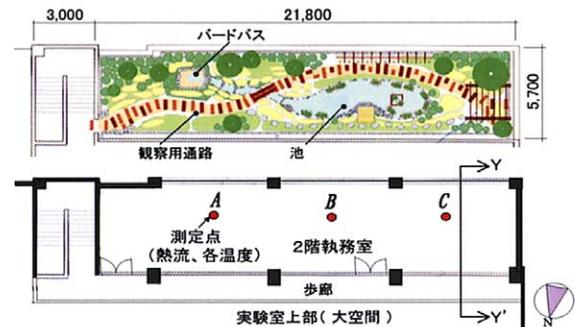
屋上ビオトープ平面図及び2階平面図・測定位置
